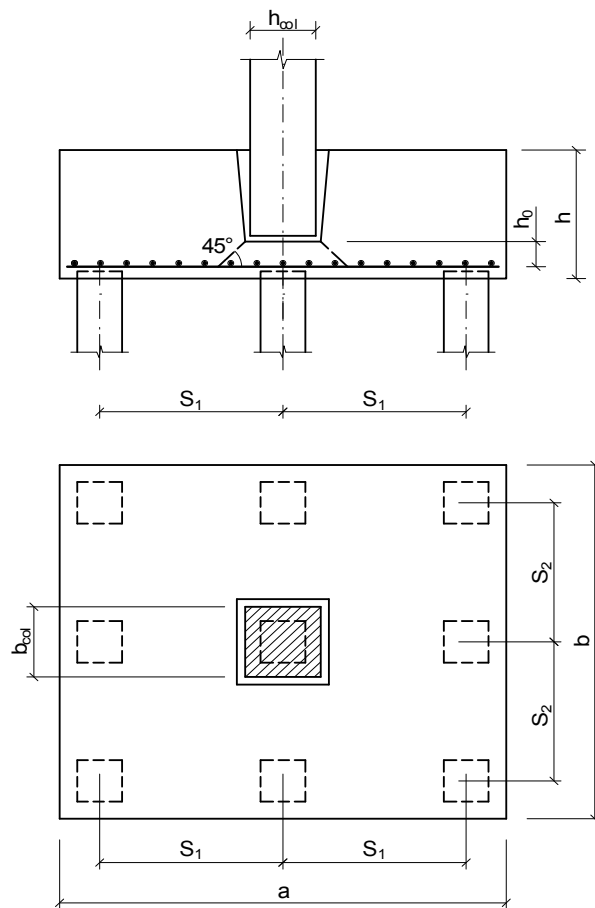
Схема пальового фундаменту з плитним ростверком
